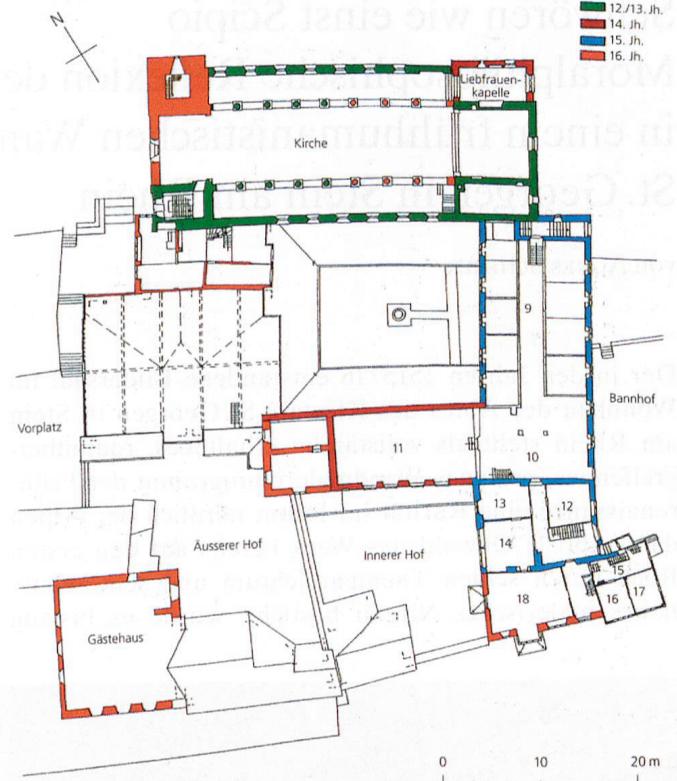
Obergeschoss-Grundriss der gesamten Anlage des Klosters St. Georgen.
